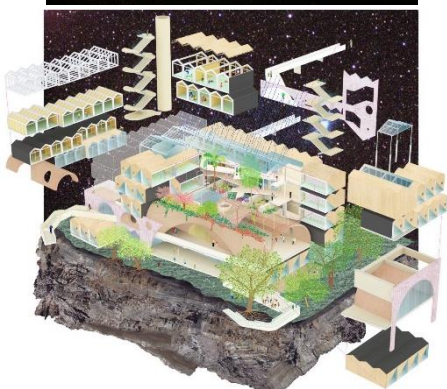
Planimetría de planta y secciones, Colegio Reggio.
